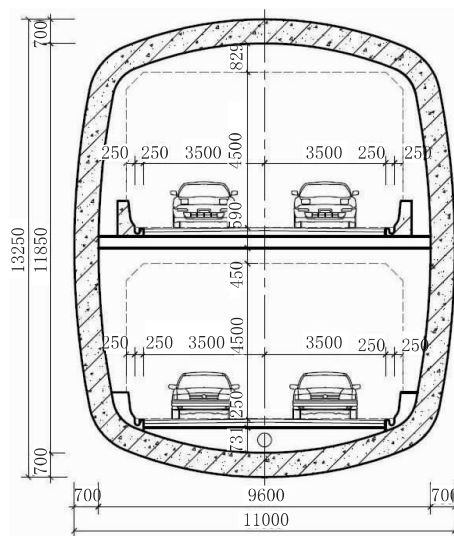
双层矩形盾构方案隧道结构横断面图(单位:mm)
